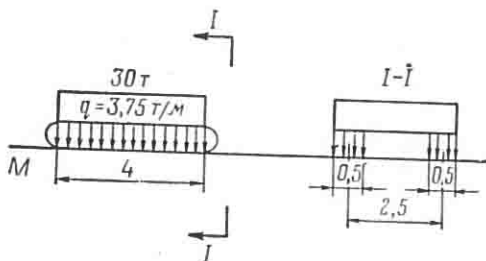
Гусеничная нагрузка по схеме НГ-30
